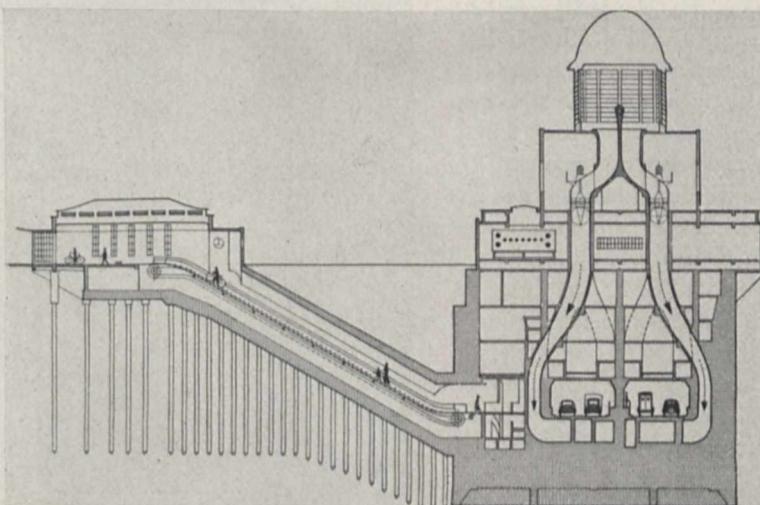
Querschnitt durch Lüftungsgebäude und Fahrtreppenschacht
